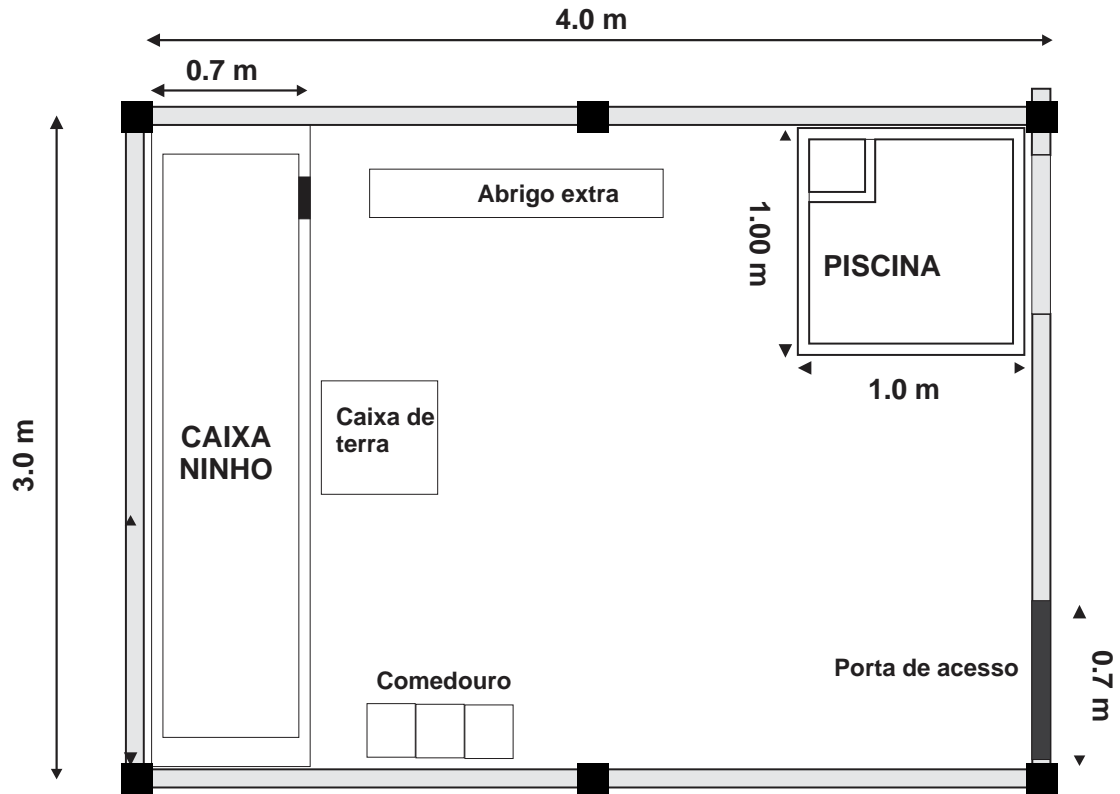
Planta baixa com detalhes do recinto experimental.
